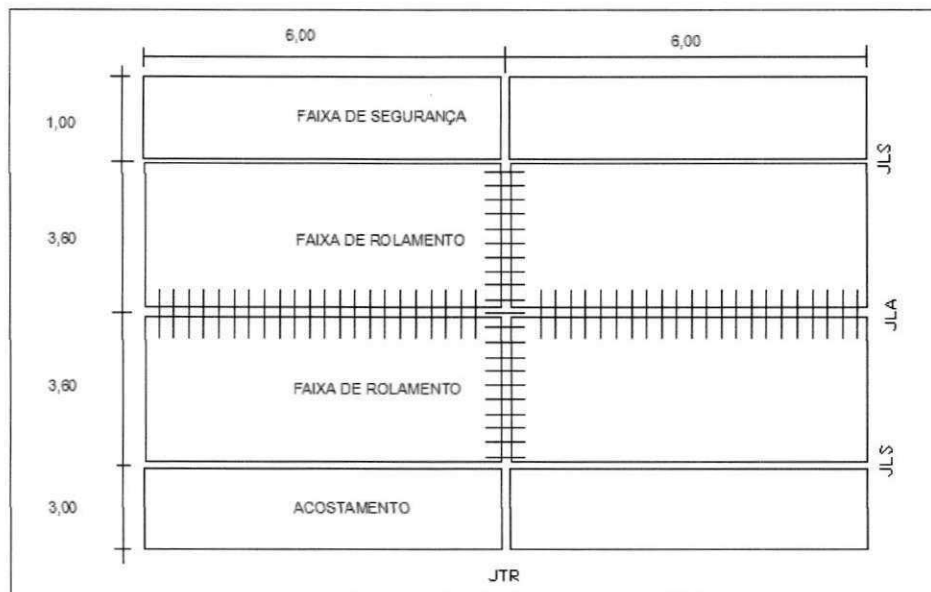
Disposições das barras de transferência e de ligação no pavimento.
